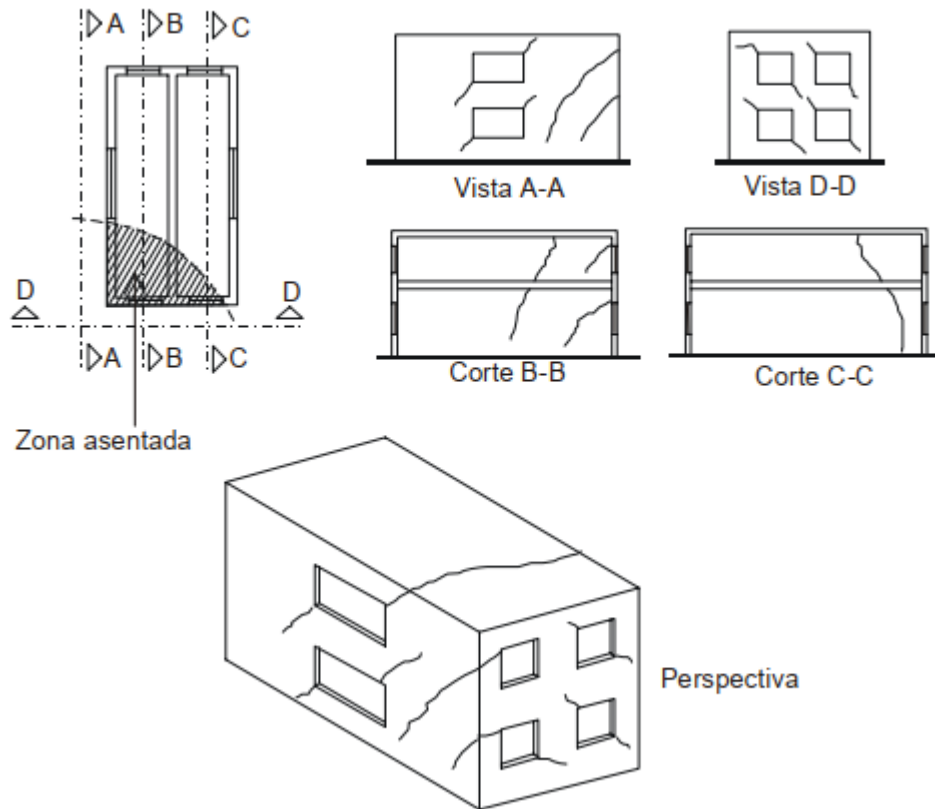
FISSURAS CAUSADAS POR RECALQUE DE FUNDAÇÕES SEGUNDO UM EIXO PRINCIPAL
